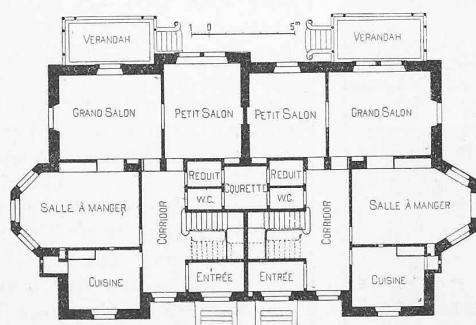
Plan du rez-de-chaussée. Echelle 1:400.
